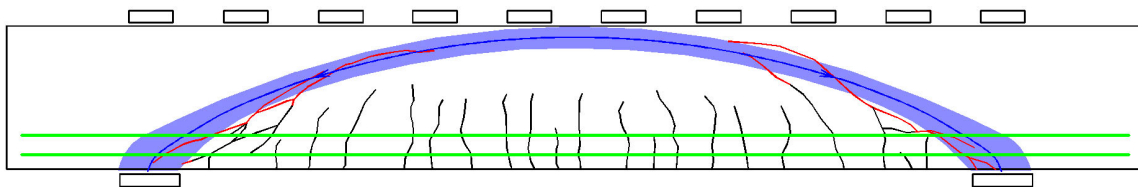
Balken BO 6 mit überlagerter Druckparabel und zugehörigen Rissen
